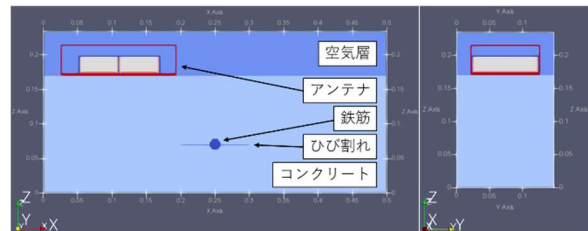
ひび割れ長さ100mmの場合のモデル1の断面図
